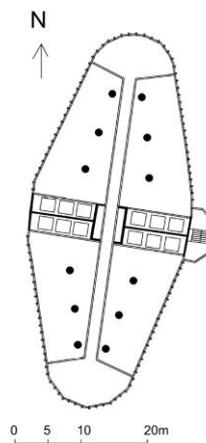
Planta do pavimento-tipo da torre de escritórios do Edifício Itália
